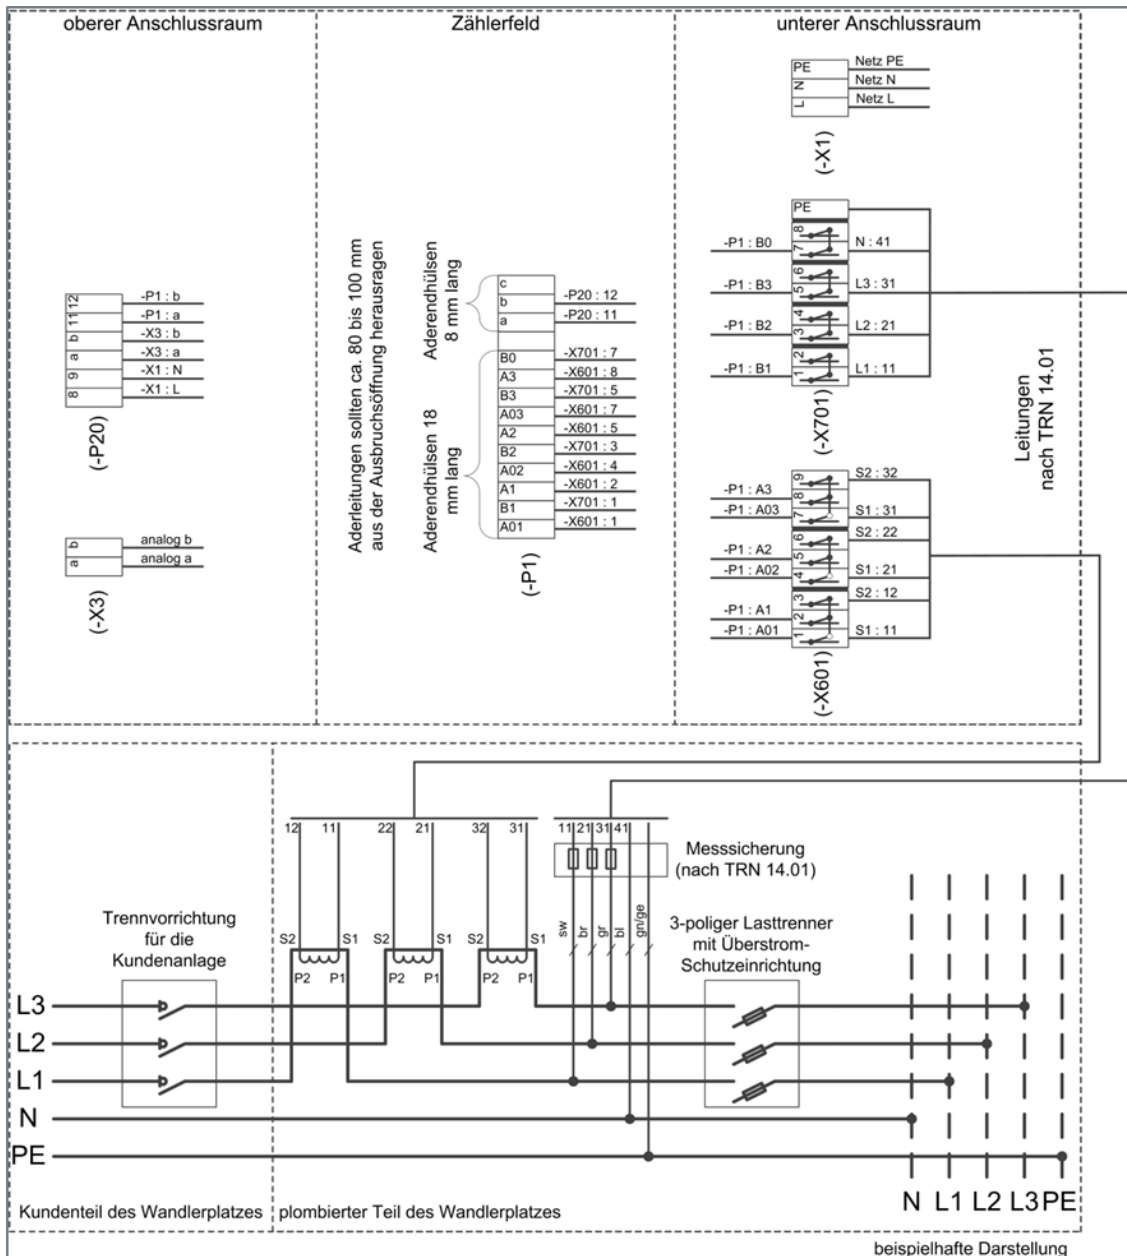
Grundsätzliches Anschlussschema einer Wandlermessung
